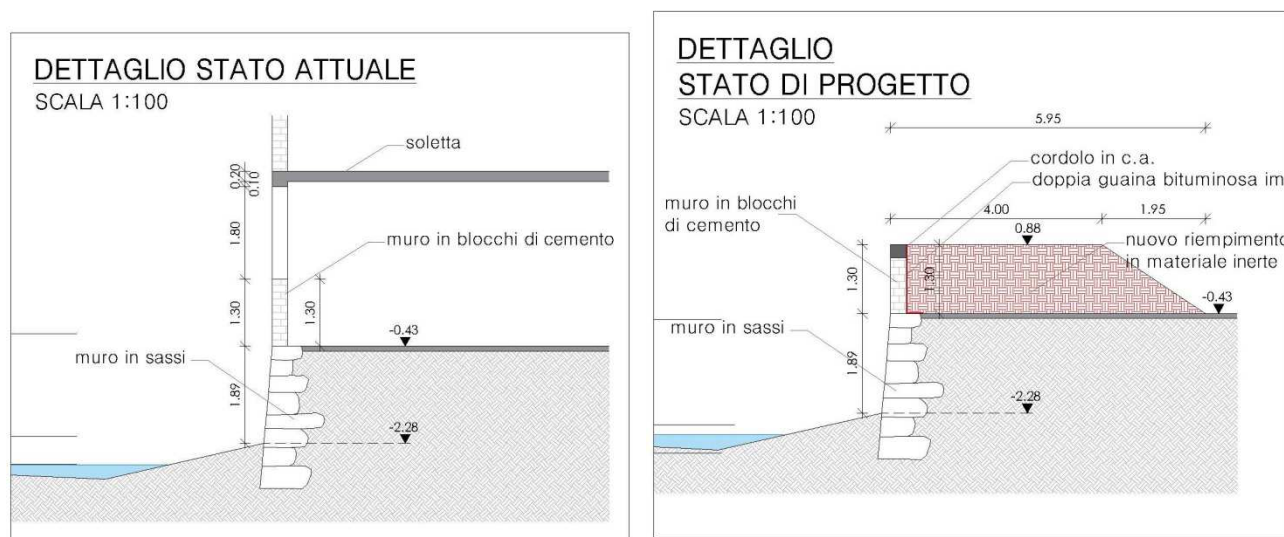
Estratto TAV 3a Dettagli di progetto di “Riempimento a sostegno del muro attualmente in precarie condizioni in attesa di un rifacimento futuro (Arch. Forti, 28.04.2016)”
